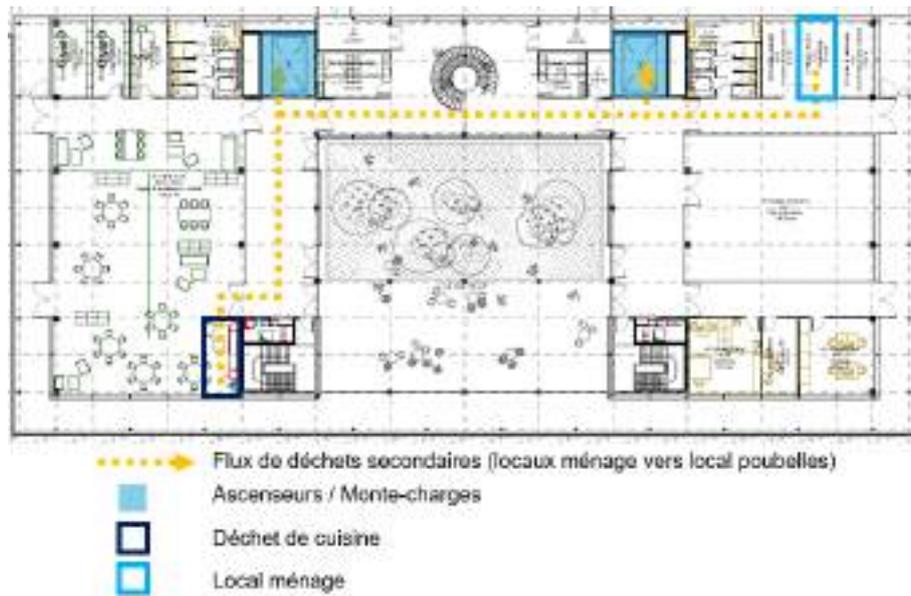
Plan de repérage des locaux et flux déchets au RDC Haut
